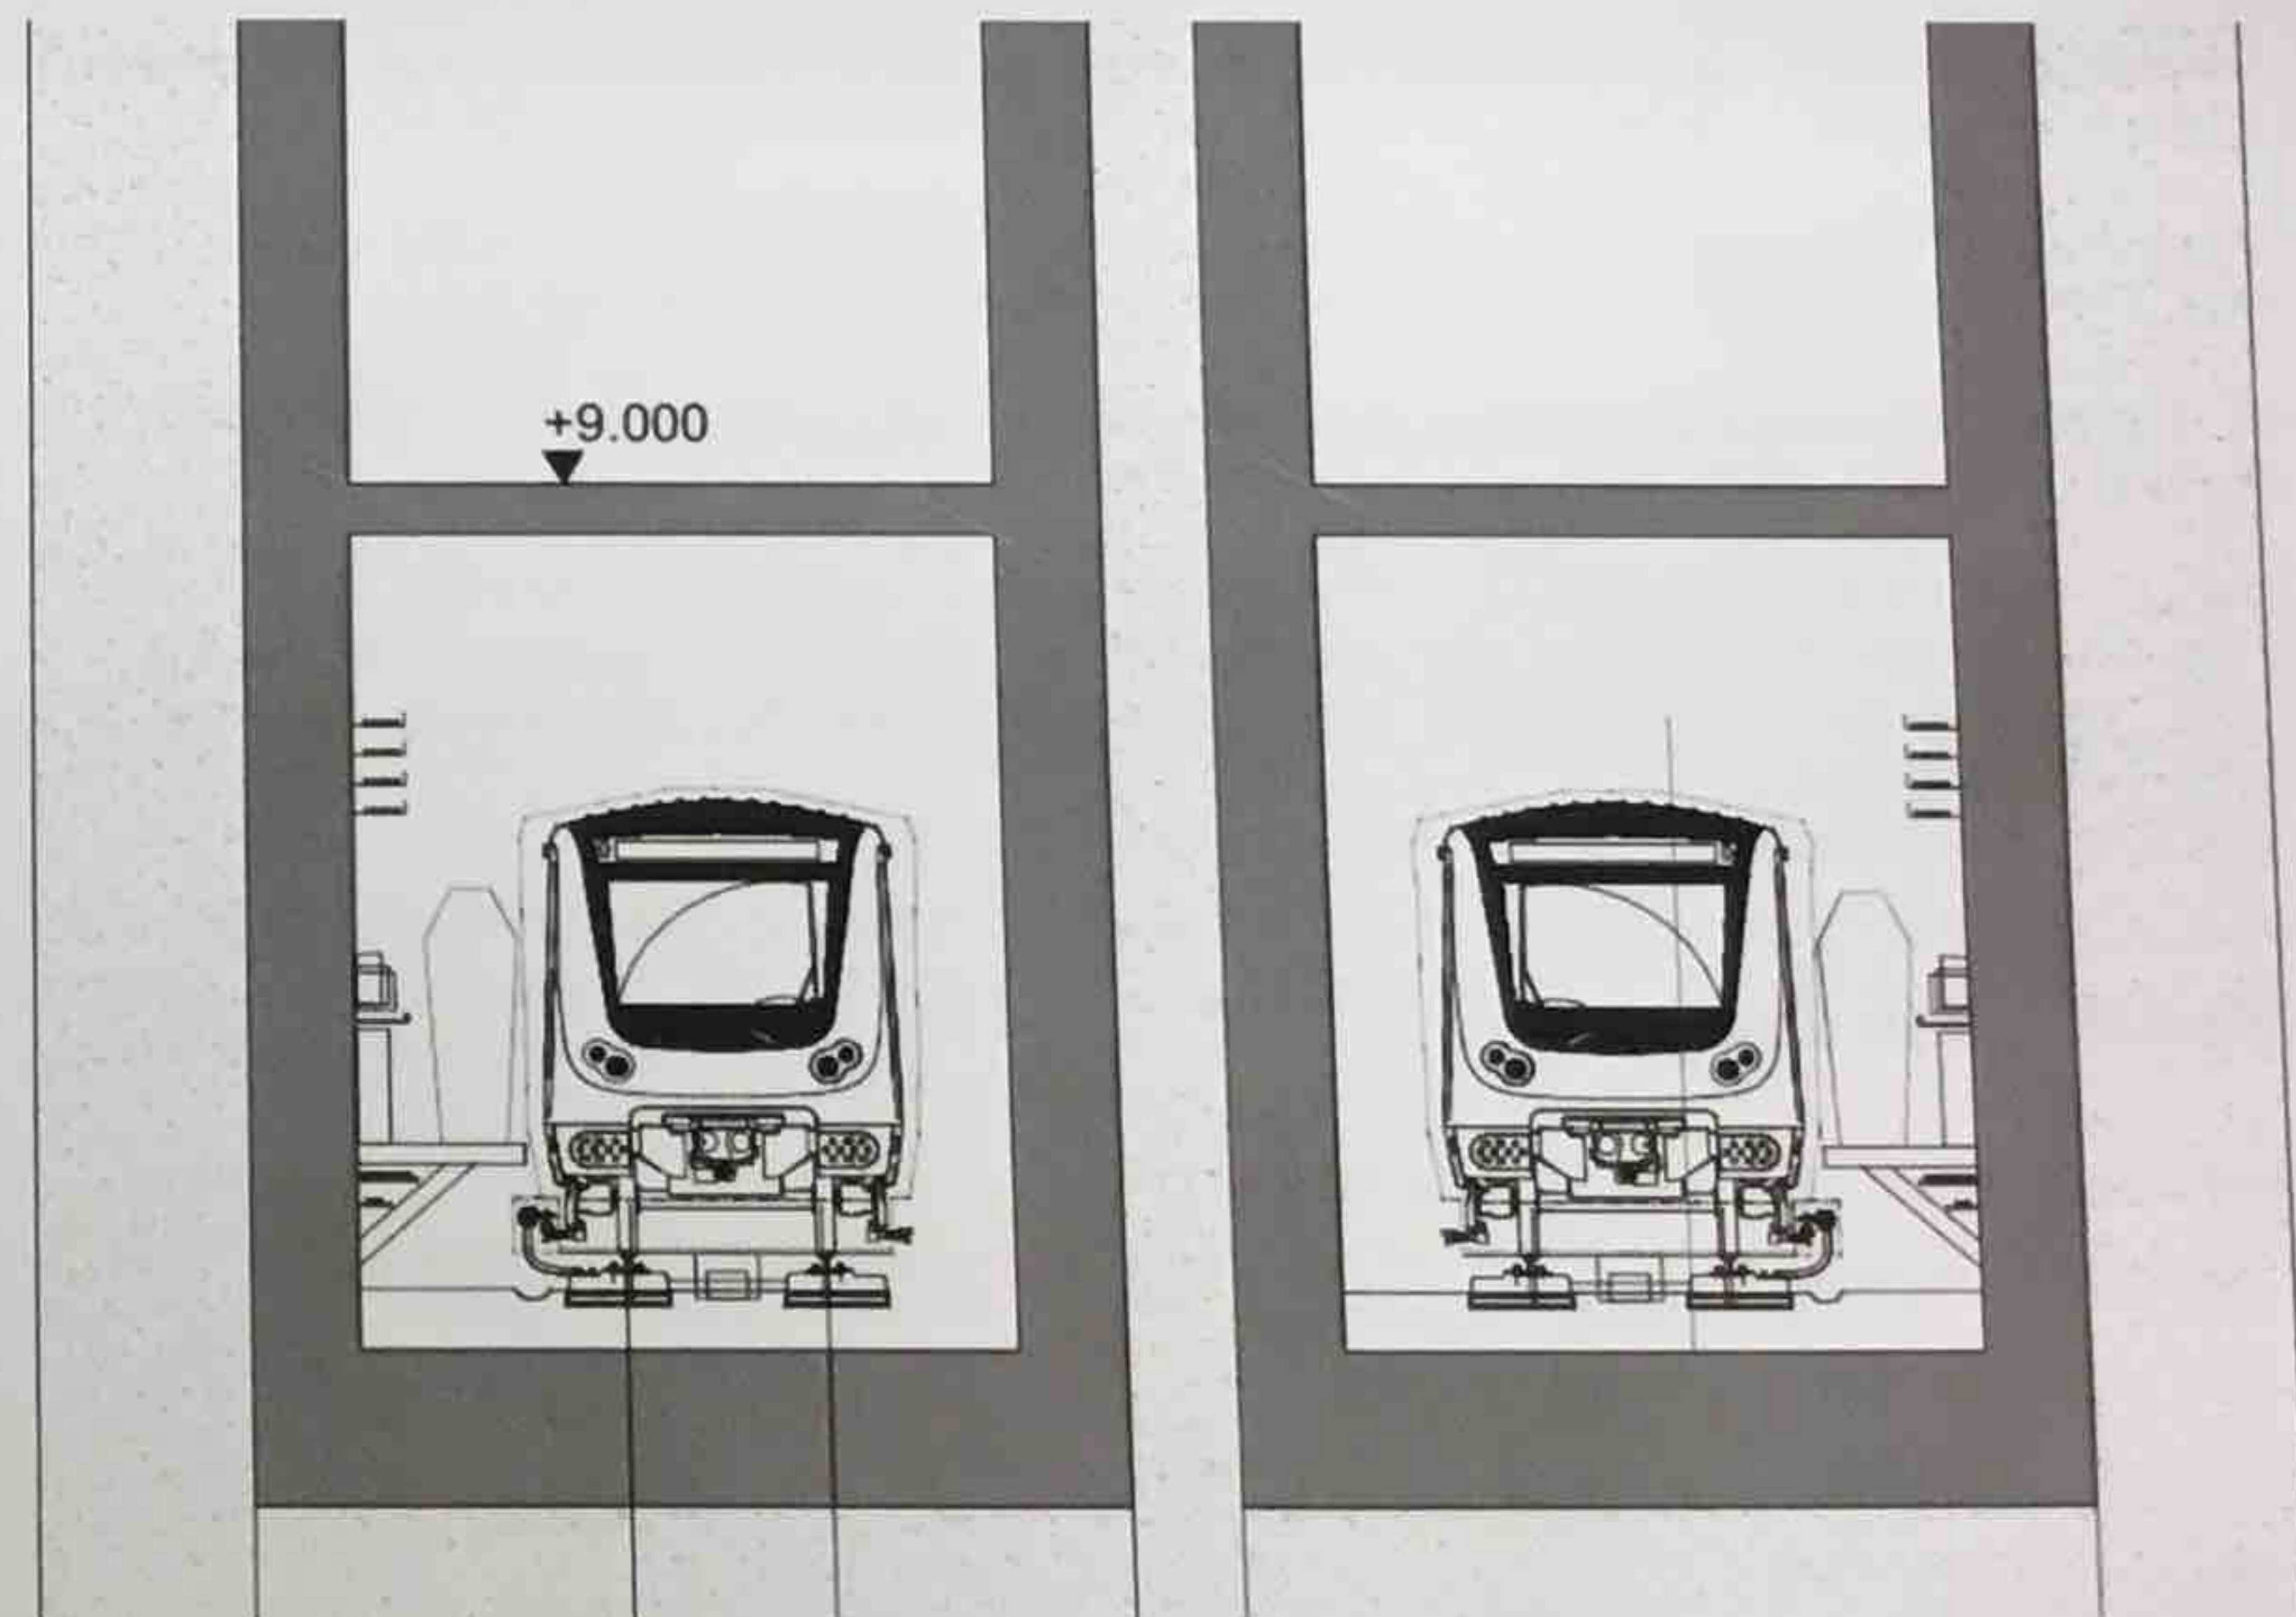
Coupe transversal type du tunnel - Coupe B-B
